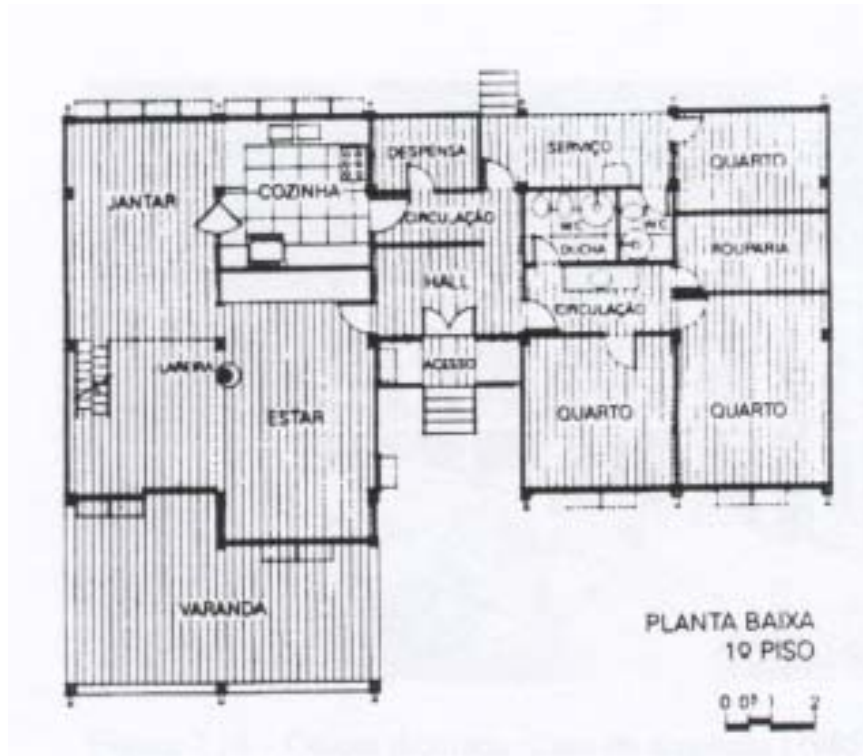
Planta do pavimento térreo. Fonte: Galvão (2001)
